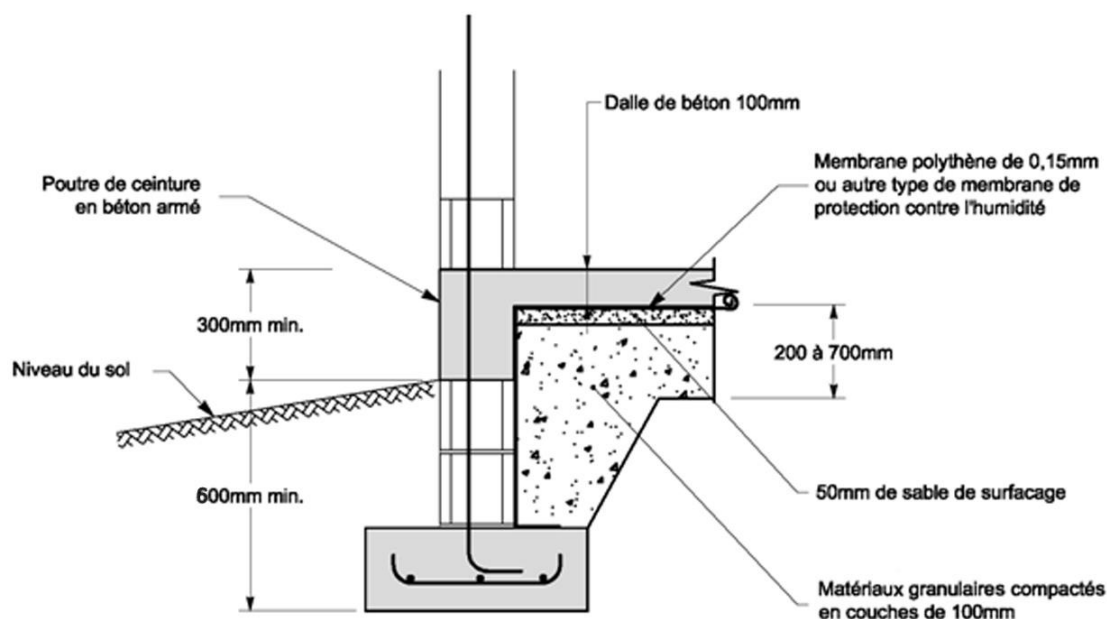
Fondation d'une dalle sur sol (Exemple d'un Mur en Maçonnerie Armée)
